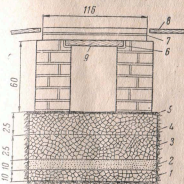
Сплошной фундамент на глинистом грунте (сверху столбики с заделкой проема задней стенки):
